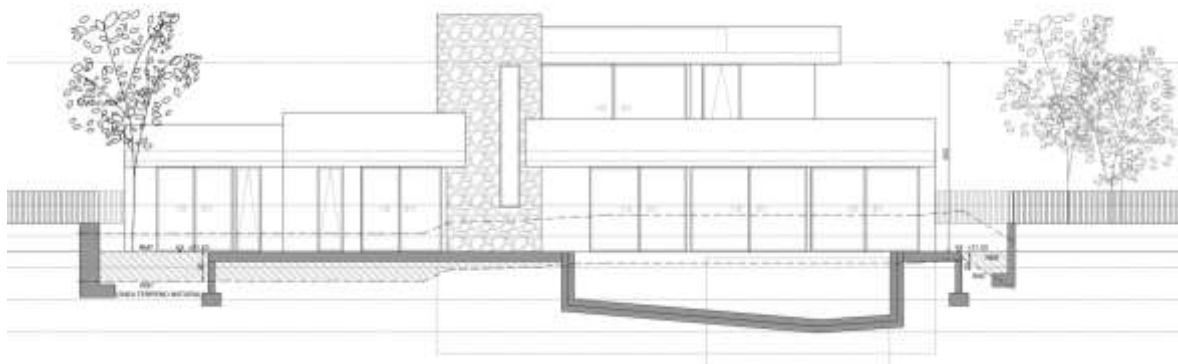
Alzado suroeste. Fuente: proyecto básico y de ejecución
